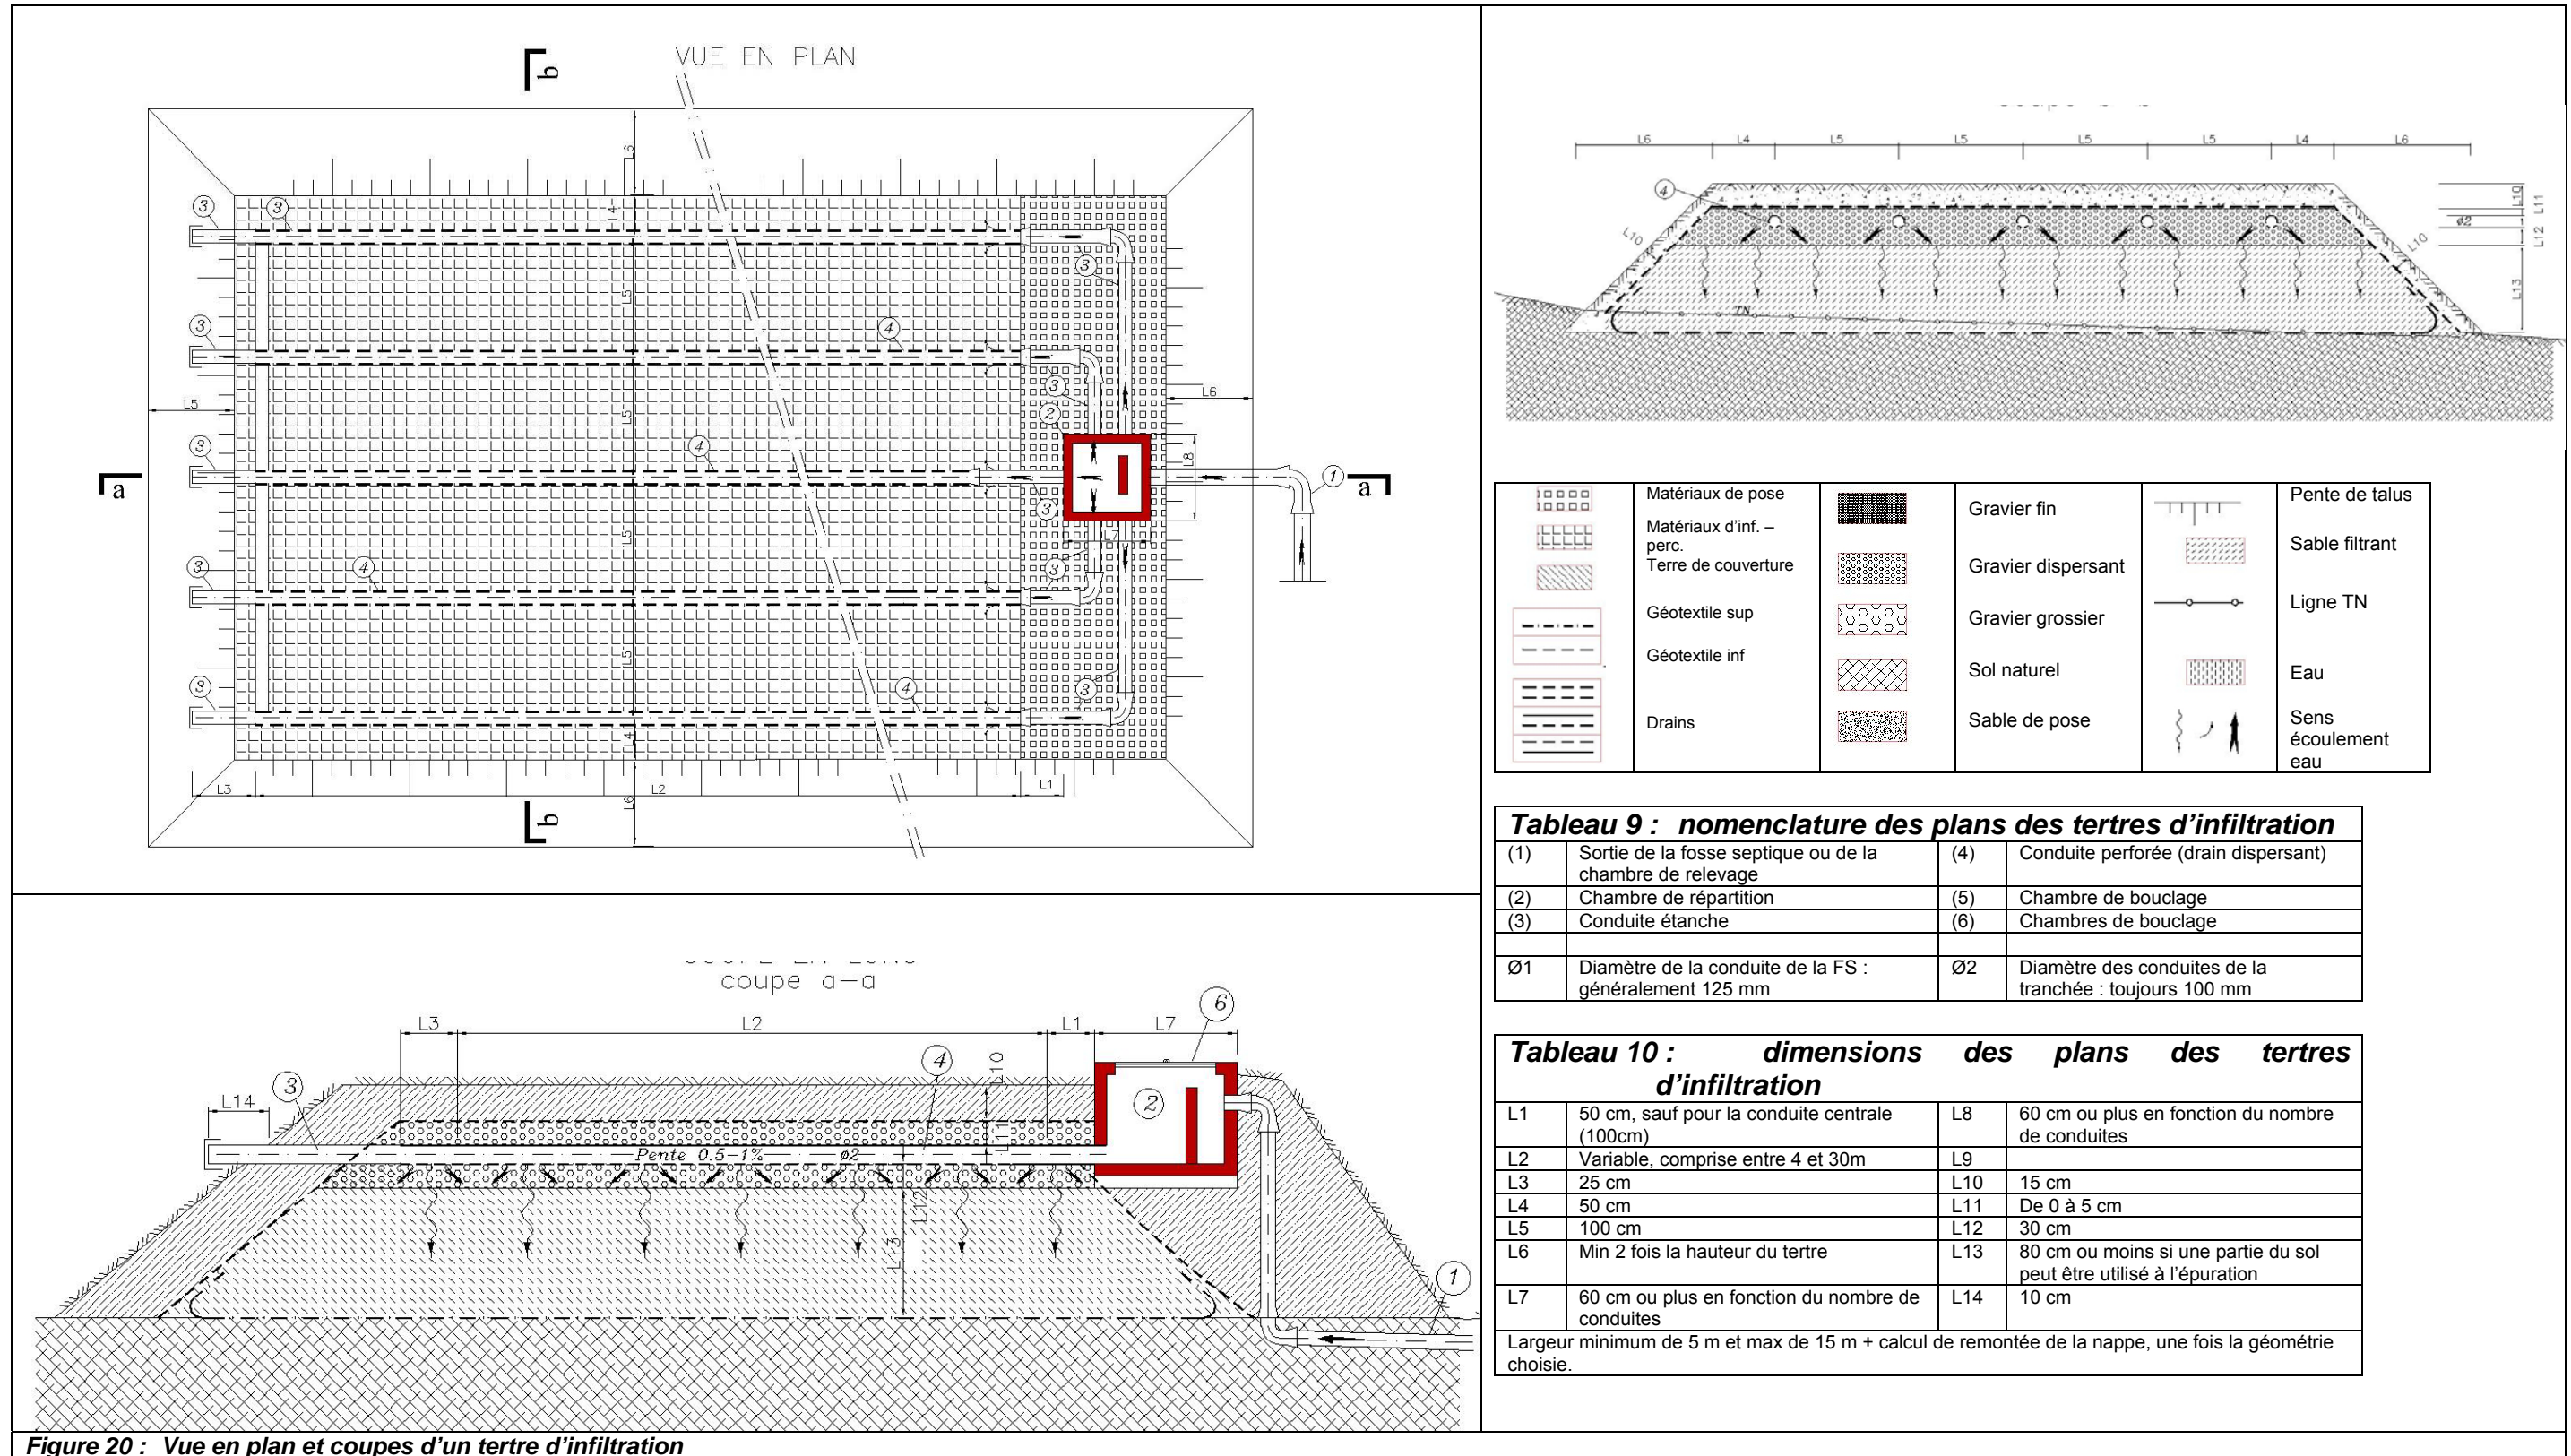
Vue en plan et coupes d'un tertre d'infiltration
